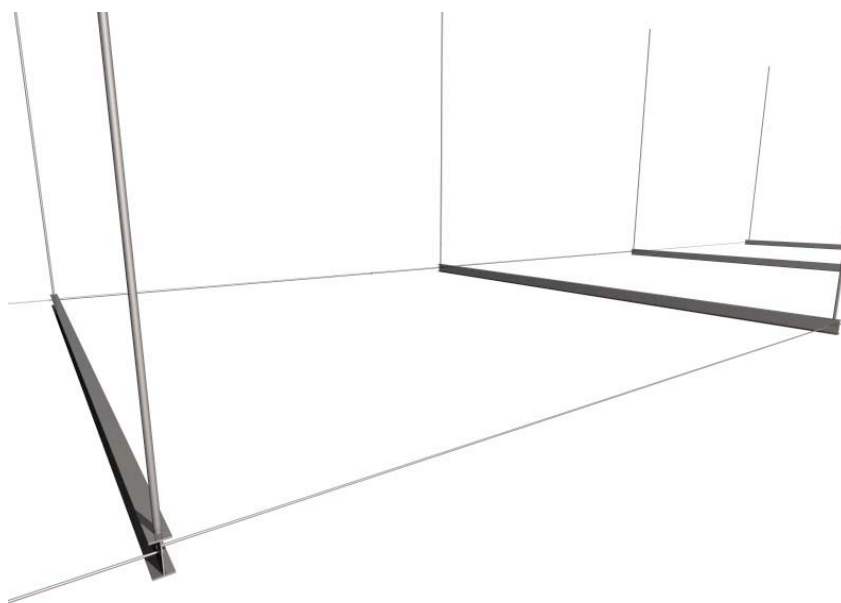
Vigas transversais temporárias e cabos longitudinais auxiliares
